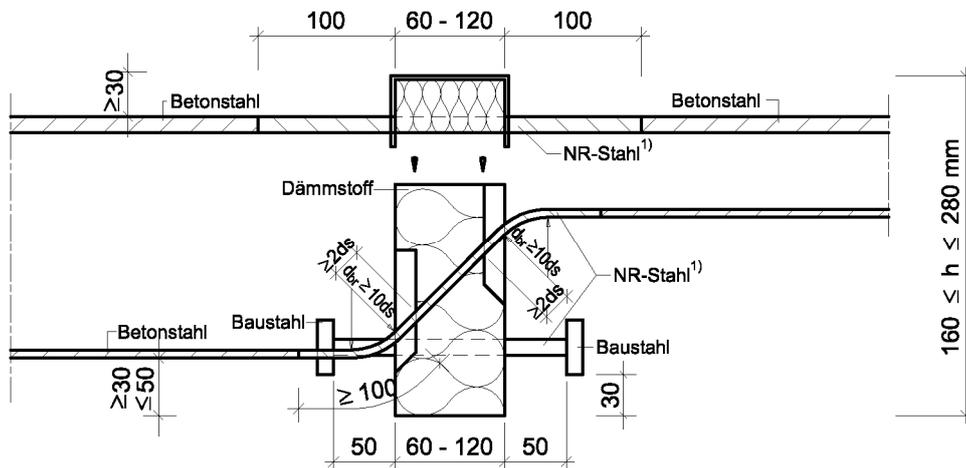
Schöck Isokorb Typ KF ¹⁾
